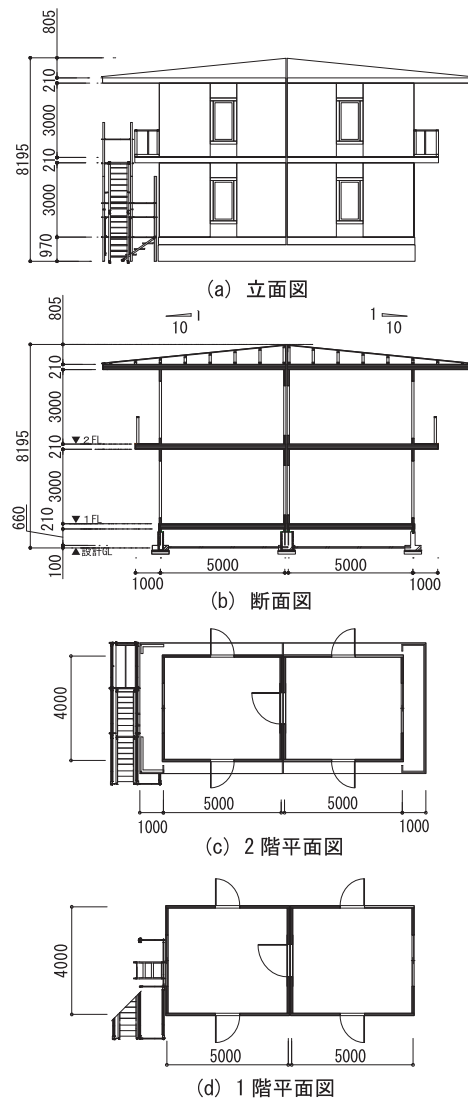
CLT遮音実験棟の立面・断面・平面図（単位：mm）
